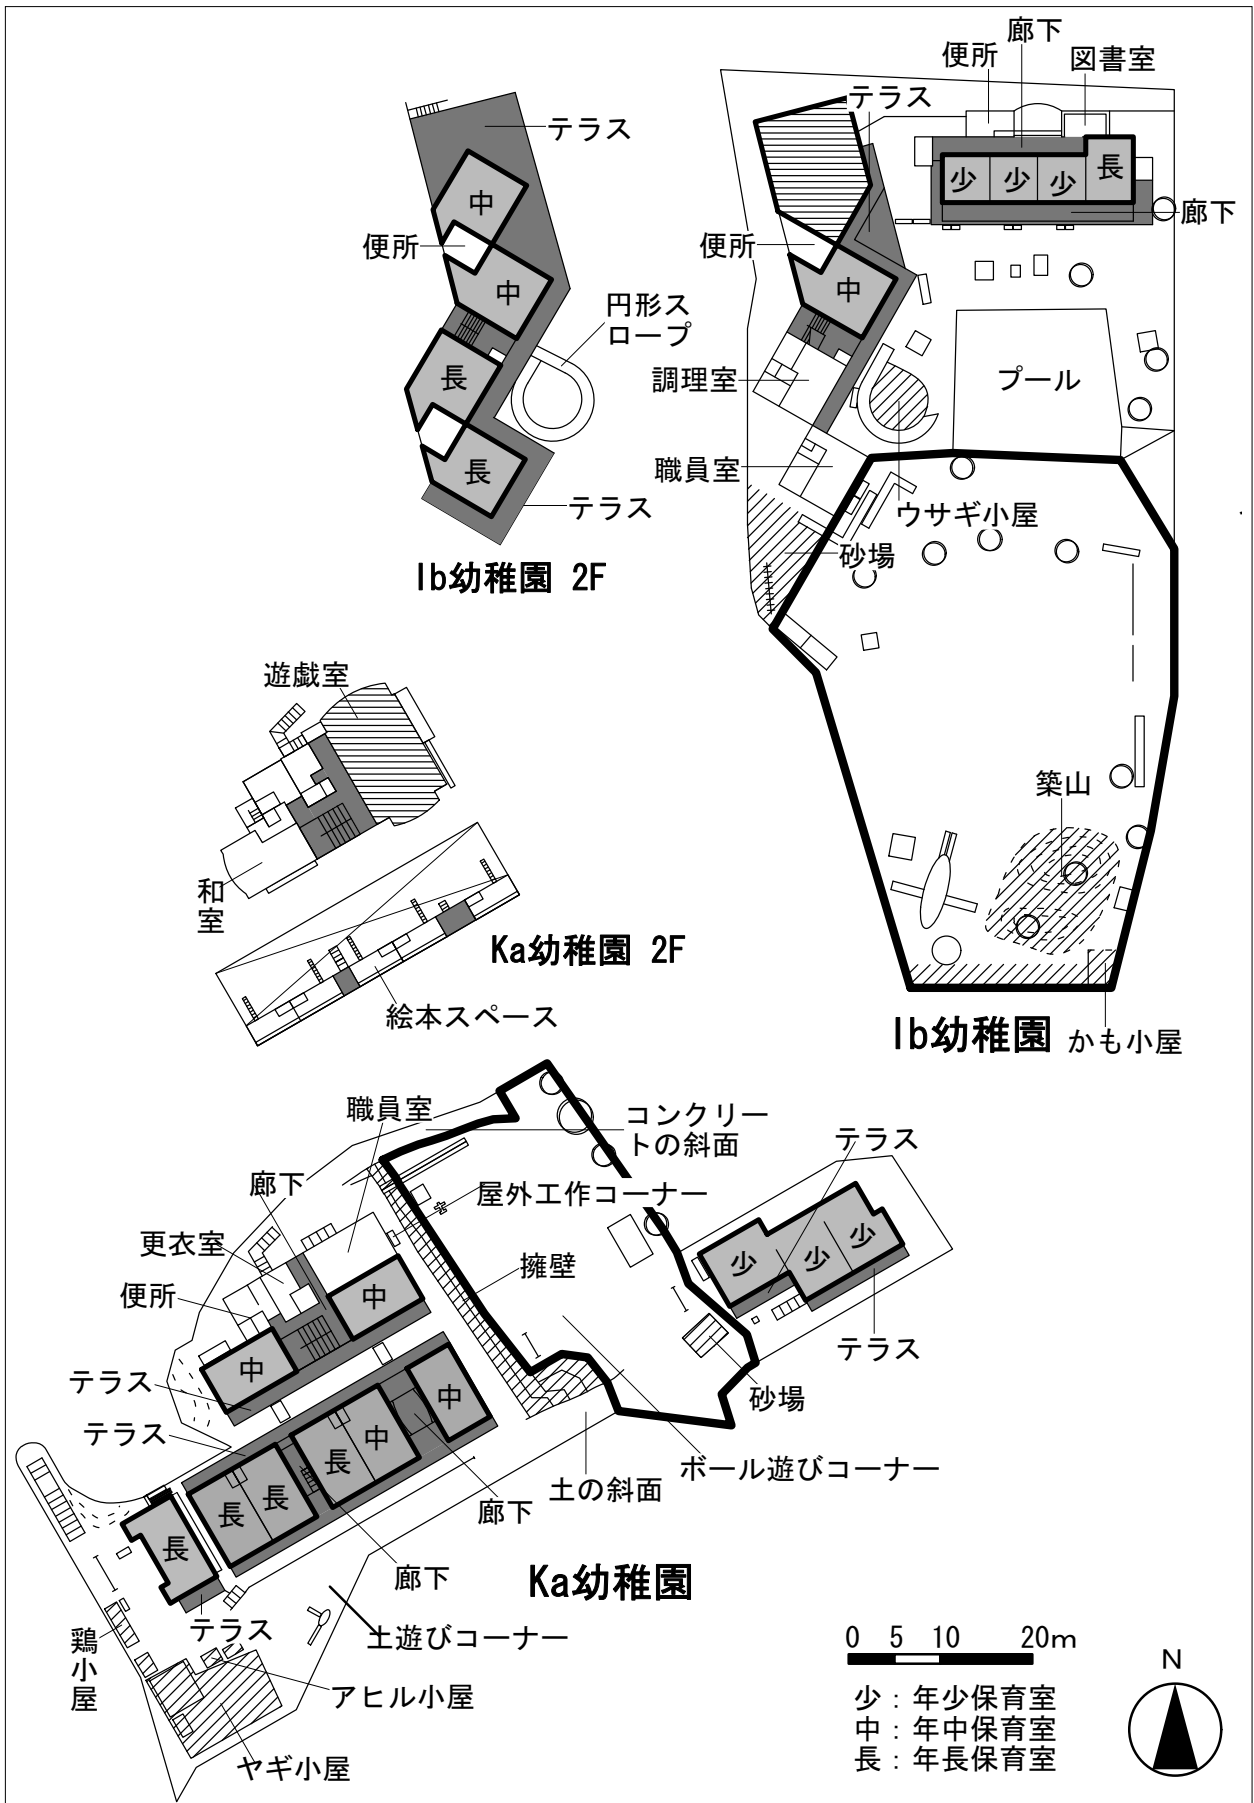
調査対象幼稚園の配置図・平面図 (拡大) Ib 幼稚園・Ka 幼稚園
